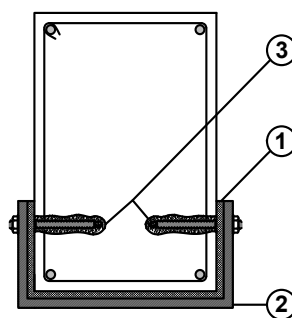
Tipologia 4: representação da secção transversal da viga reforçada. Legenda: 1 – resina epóxi; 2 - chapa metálica; 3 – cantoneira de aço.
